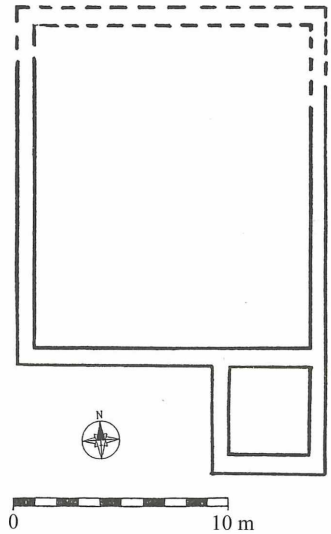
Schematischer Grundriss der Festung auf Naqb ar-Rubai (Zeichnung U. Hübner 2007)
